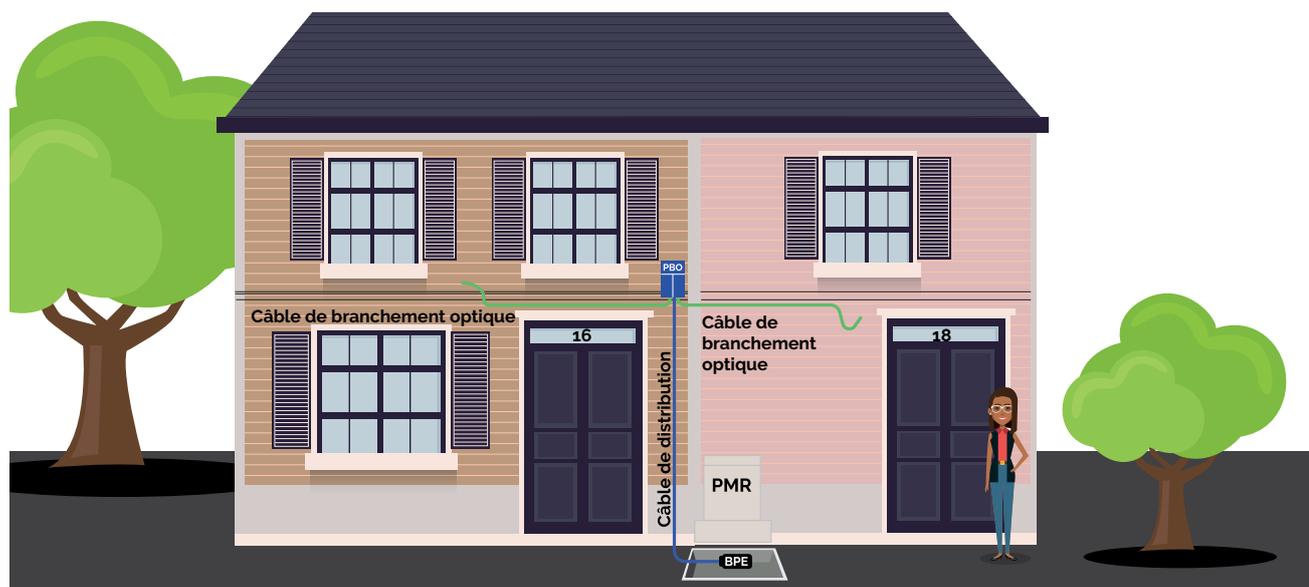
| Cas d'un branchement à partir d'un PBO sur façade
